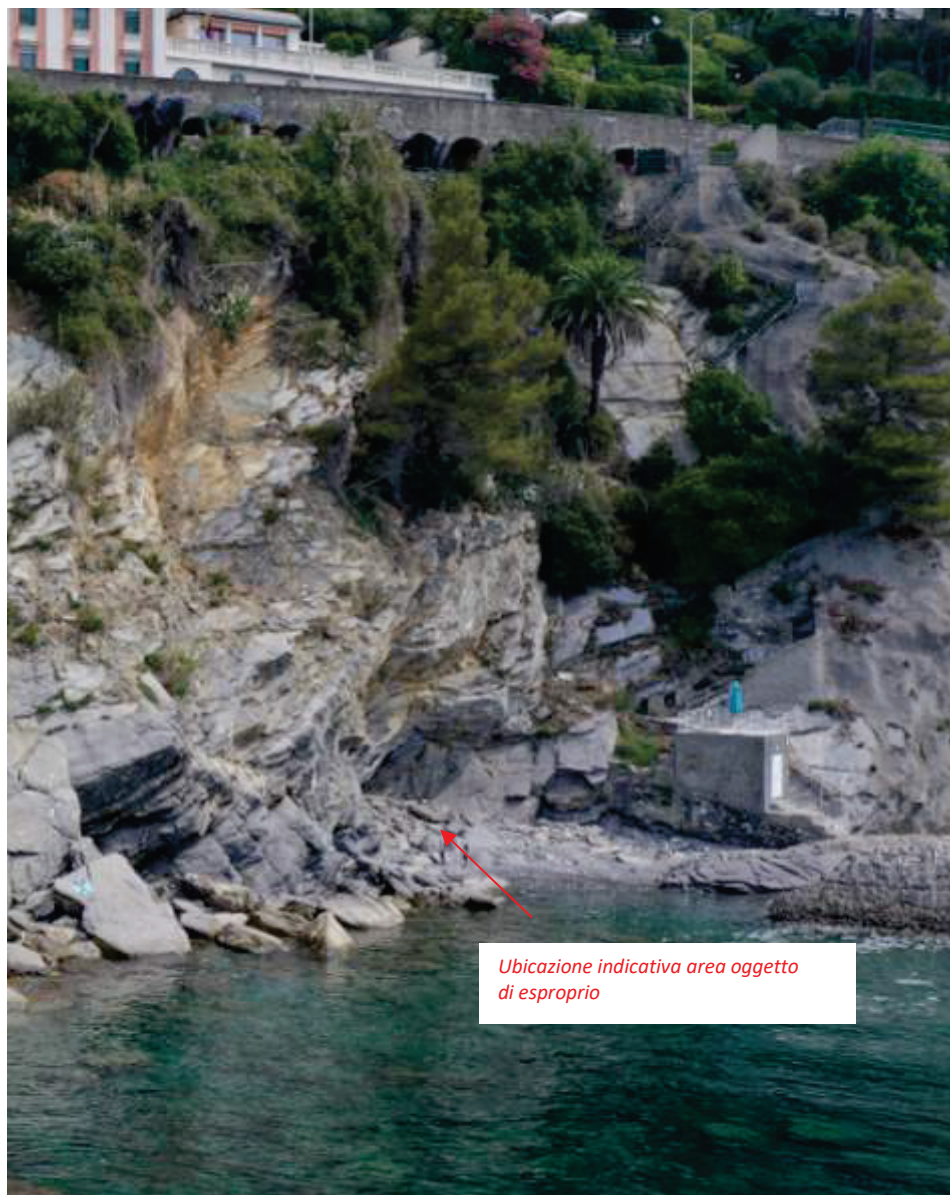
dettaglio dell'ubicazione della minima porzione del mappale 878 oggetto di esproprio
